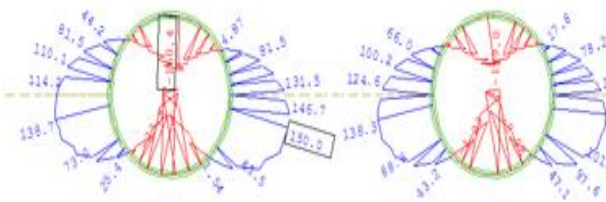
Эпюры моментов, возникающие в конструкции железобетонной обделки на стадии завершения строительства тоннеля
